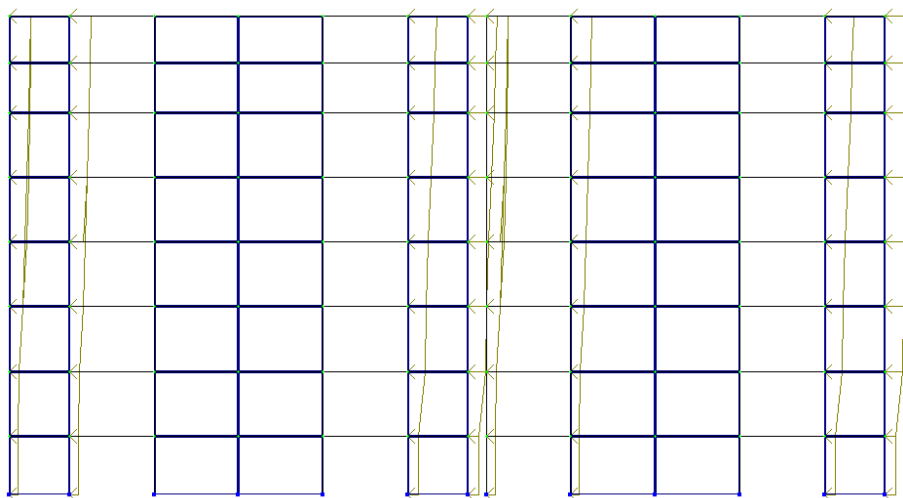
Схема вітрового навантаження на продольну раму, вітер з права
